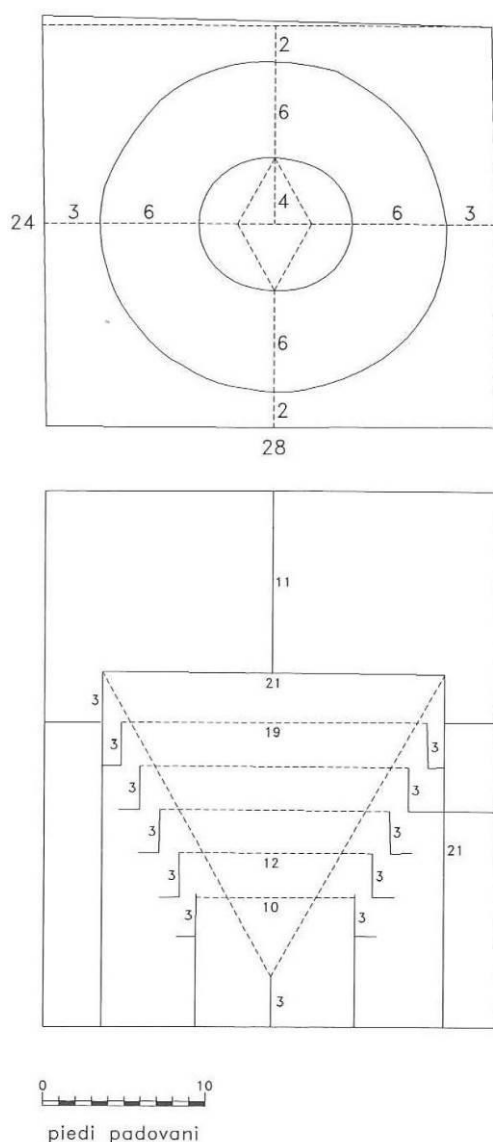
Schema compositivo in piedi padovani della pianta e della sezione longitudinale
